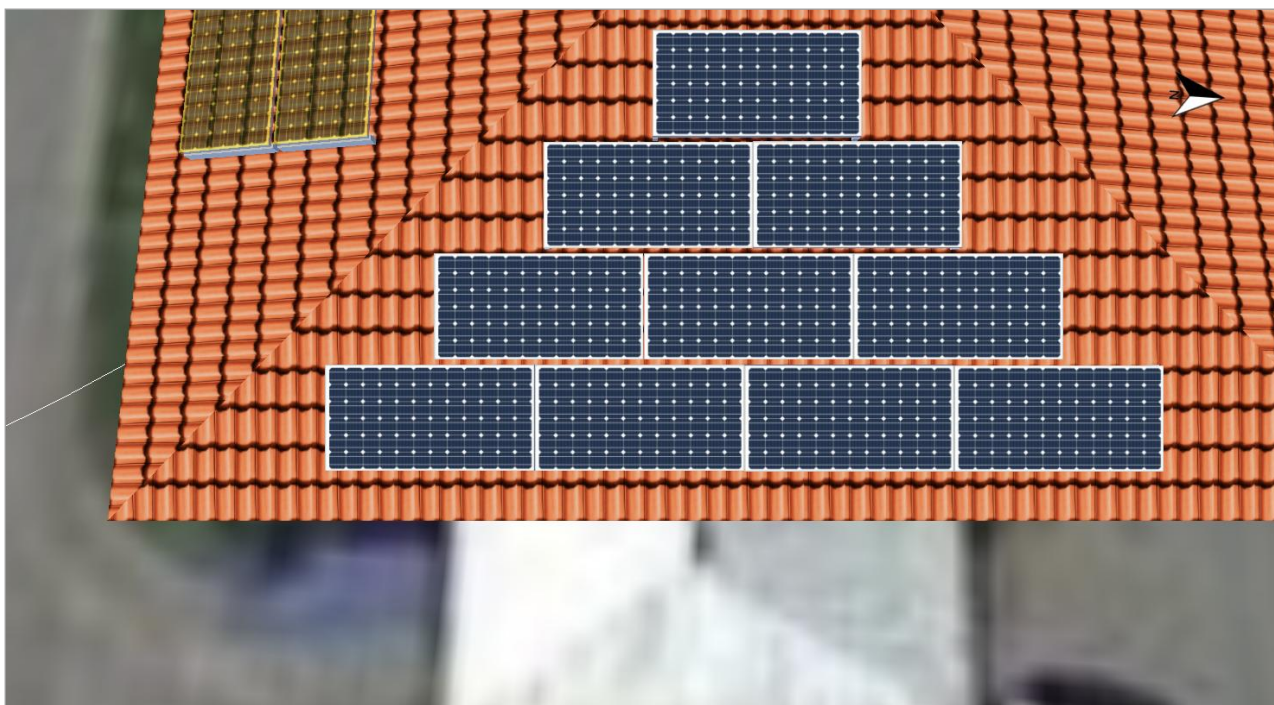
Plocha modulu - C2\_prava-Roof Area South
